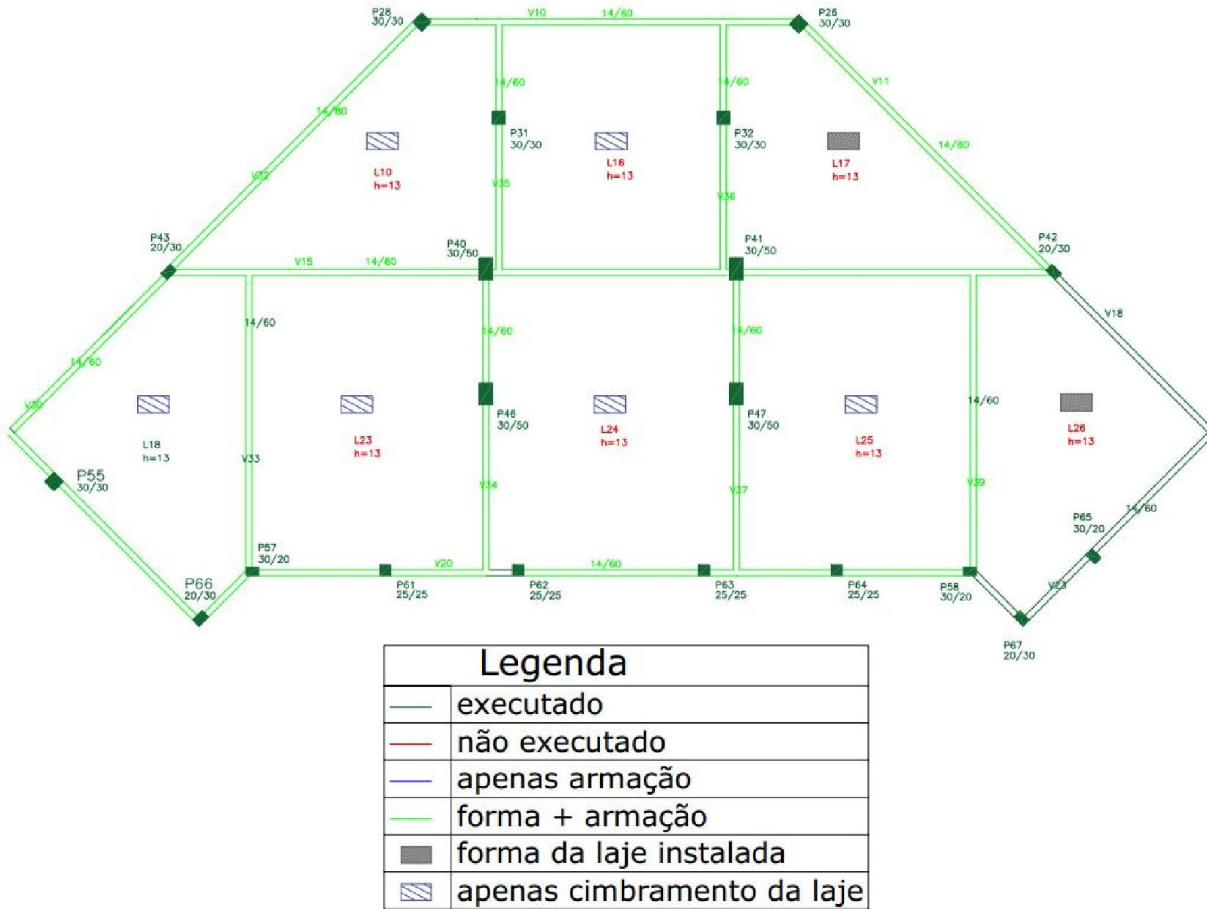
Mapa iluminado do HALL do pavimento de cobertura.
